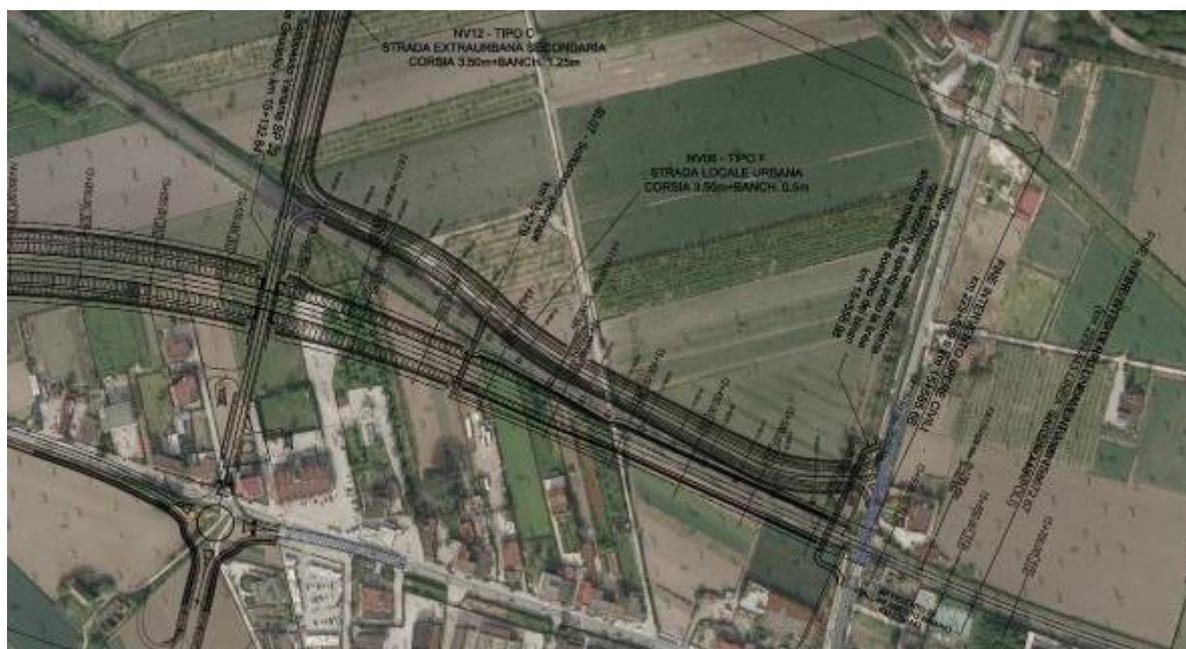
Contesto di analisi G – Progetto Esecutivo - Planimetria (in rosso la nuova viabilità)
